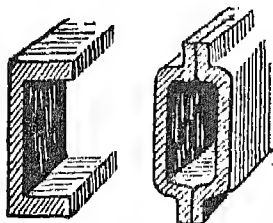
Exemples de sections de poutres métalliques utilisées pour longerons.
